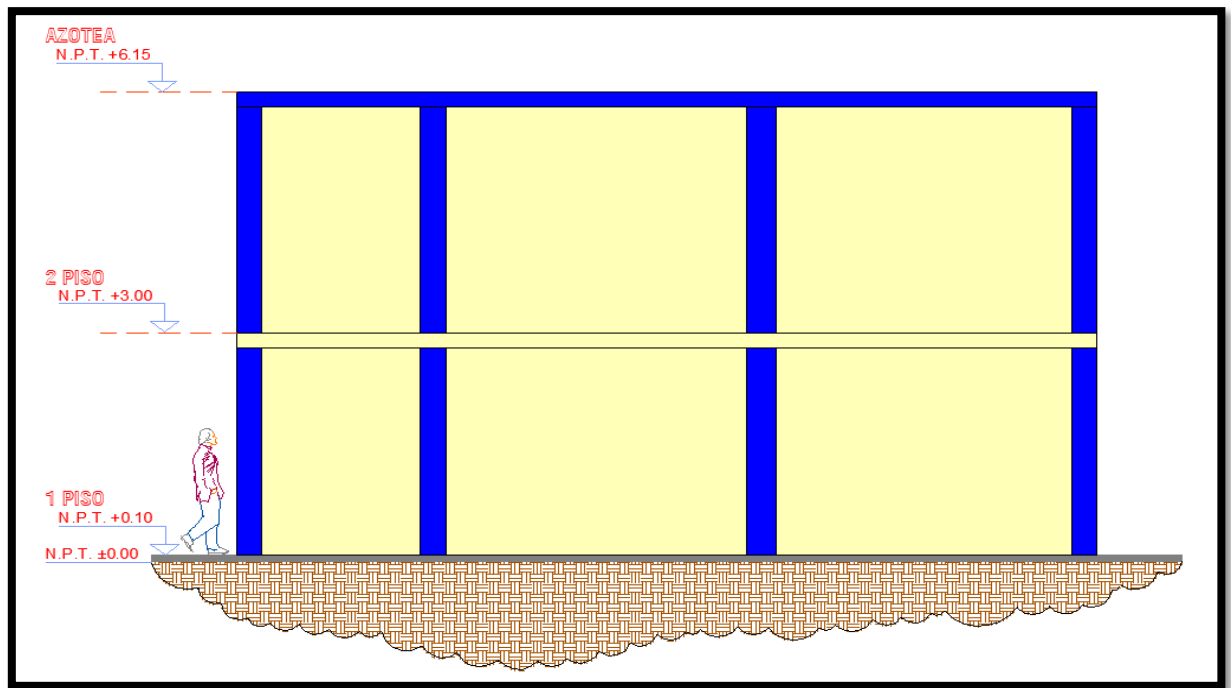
Plano de elevación corte eje: 1-4/E-E - vista frontal del pabellón "C"
